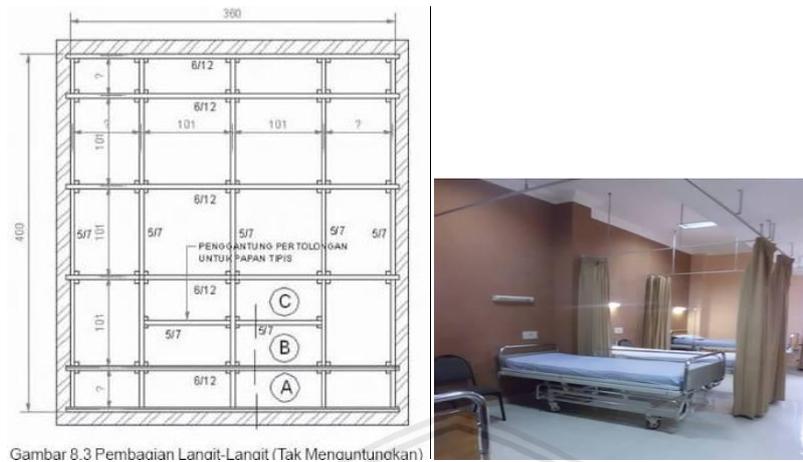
Detail lantai dan suasana pada ruang rawat inap.
